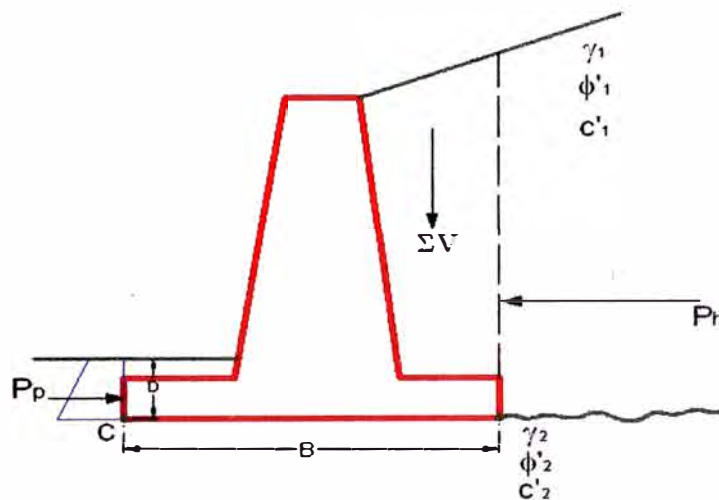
Fuerzas verticales y horizontales que actúan sobre un Muro de Gravedad
